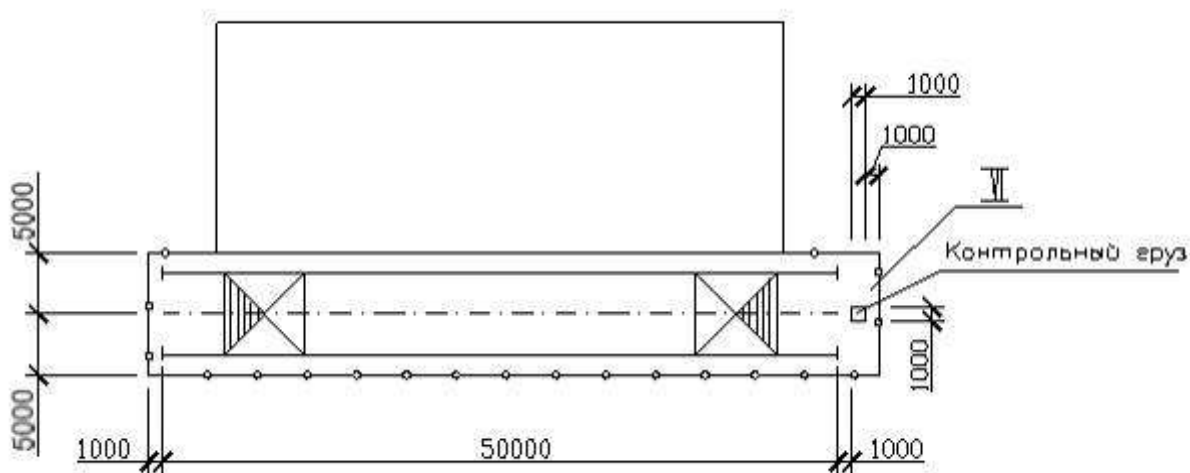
Опасная зона подкрановых путей. VI – опасная зона подкрановых путей
